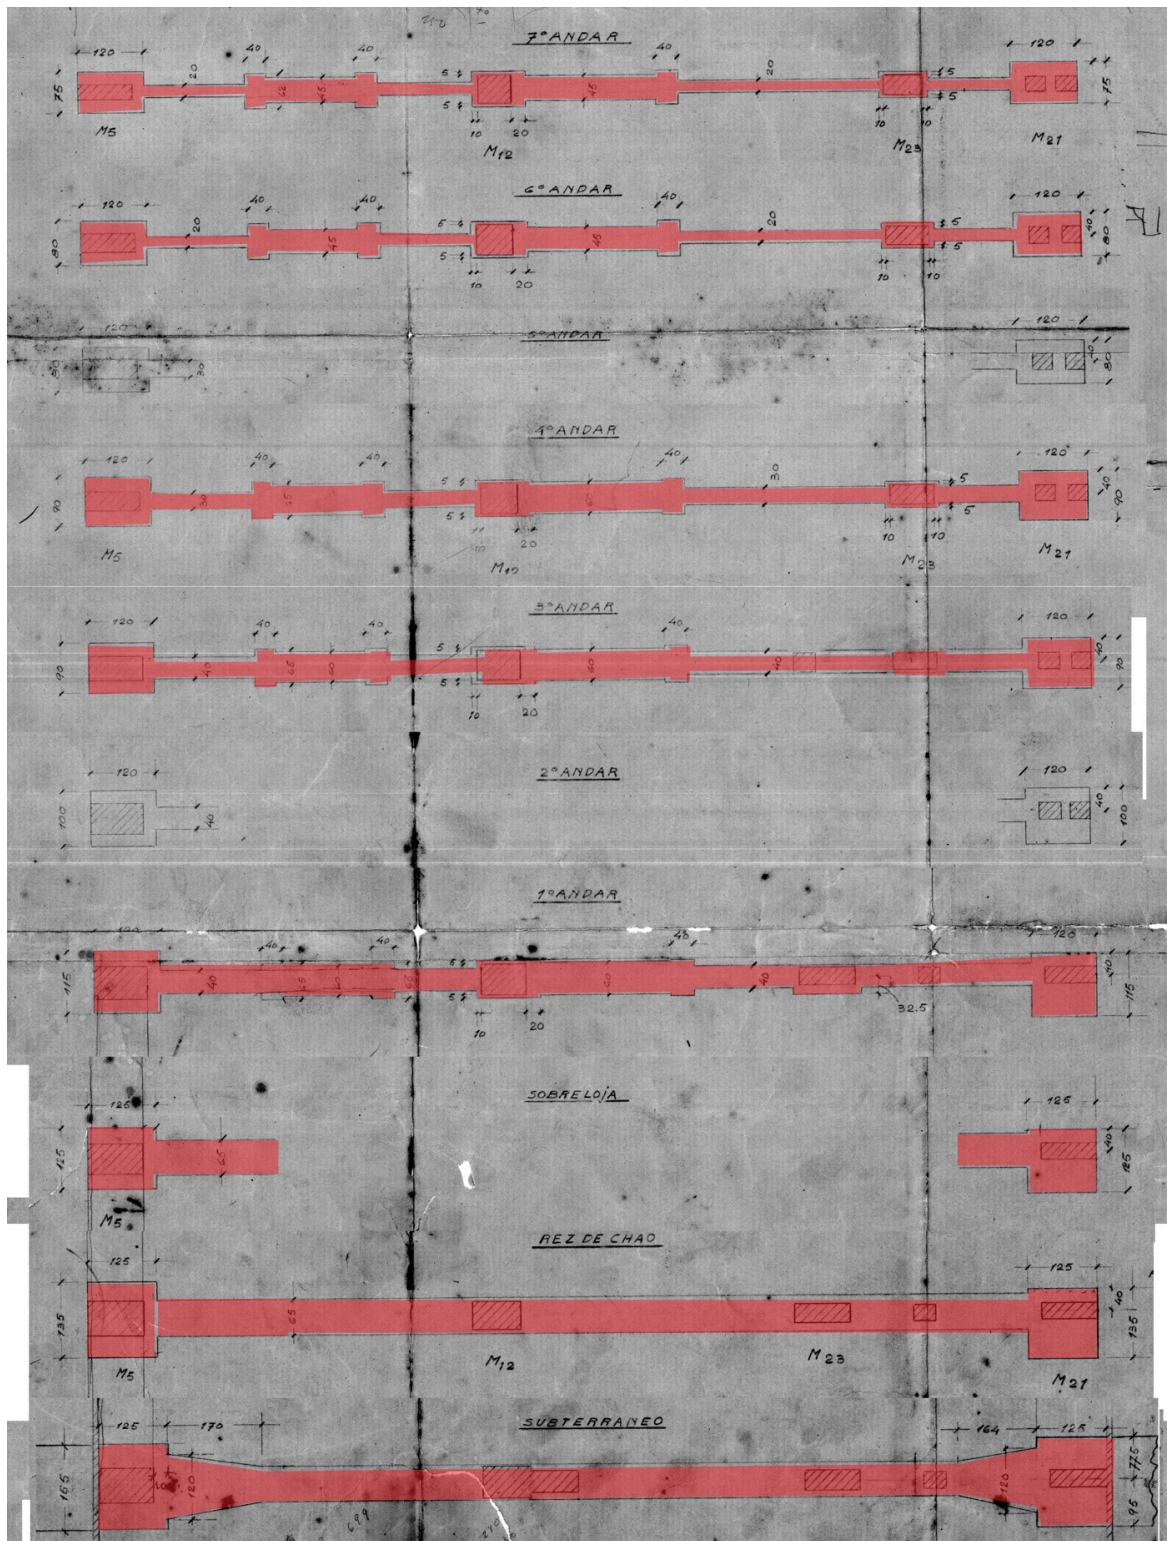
Planta de Contraventamento do Subterrâneo (Subsolo) ao 7º andar. Edição e cromatização em vermelho pelo autor. FONTE: SEECLA, 2014.
